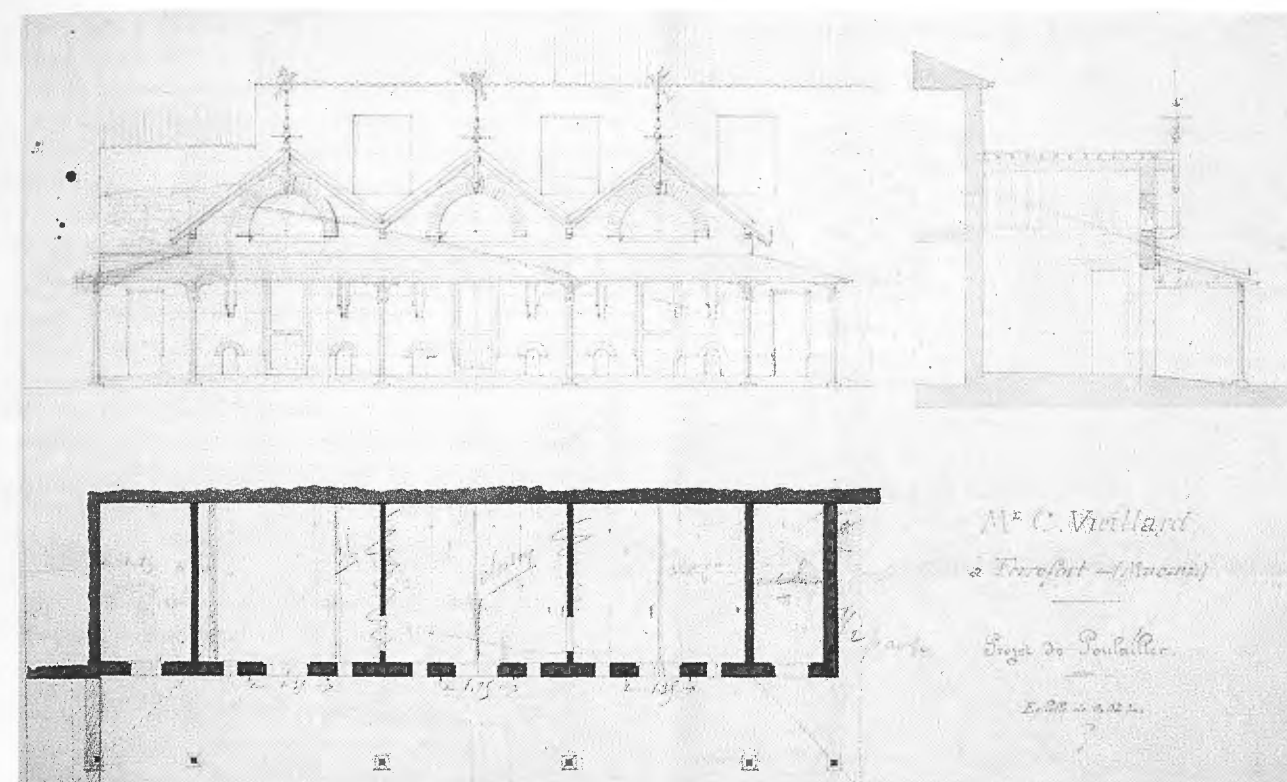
Château Larriou-Terrefort (Macau), Poulailers. Élévation, plan et coupe, fonds Garros, A.M.Bx.
